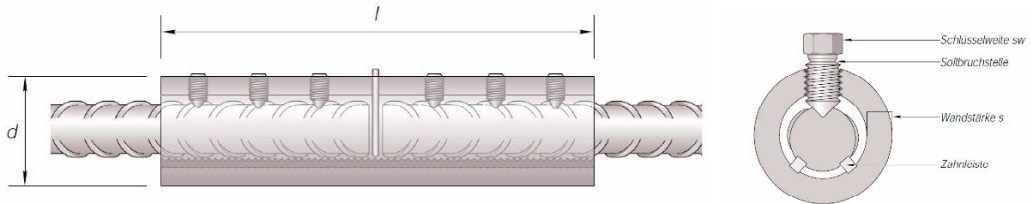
Steckmuffe, deren Pressschrauben die schlüssige Verbindung mit dem Abscheren garantiert (Bild 9.13)
